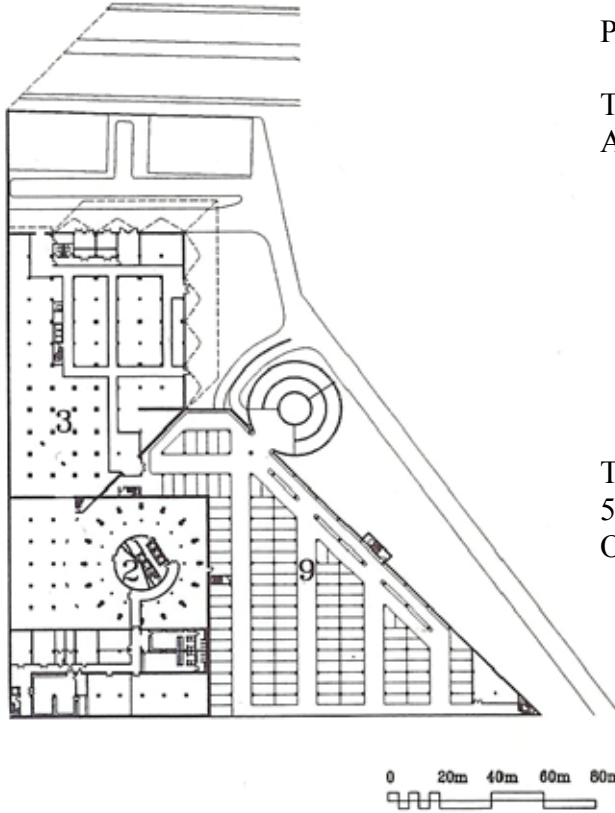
BTM Orta Kot Planı [26,27,30]
